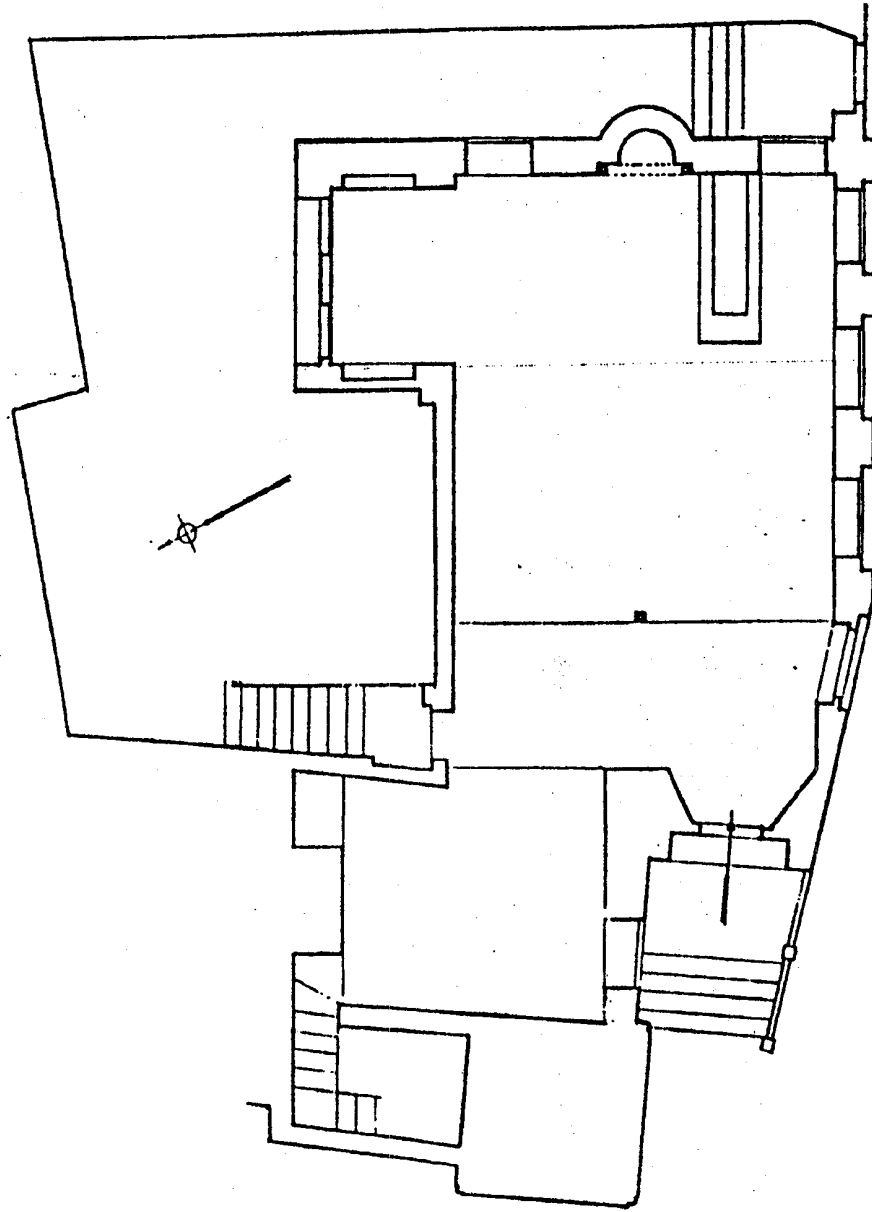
مسقط أفقي لجامع تنم رصاص المعروف بجامع تميم الرصافي
